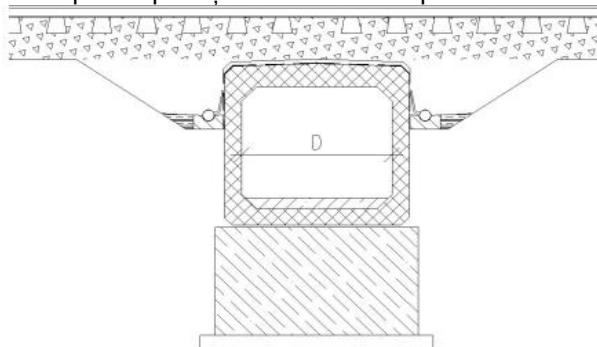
Exemplu de podeț realizat din cadre prefabricate din beton armat
